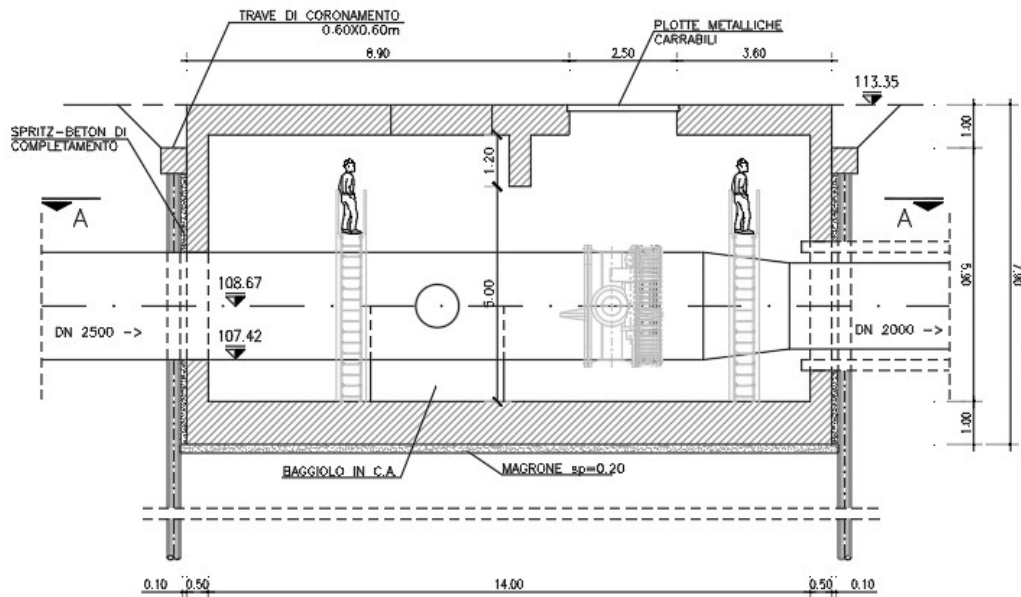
Pianta e sezione del Partitore Monte Mario.
